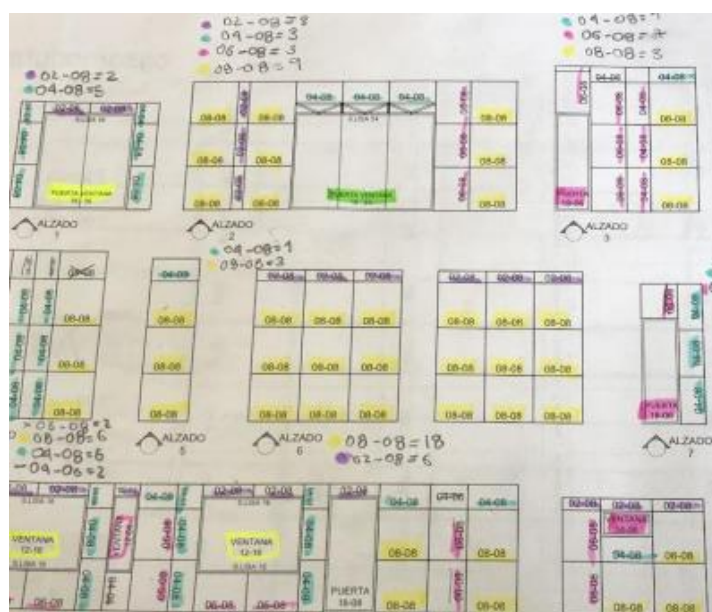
Cuantificación de obra manualmente estructura de cubierta y cálculo de tubos
